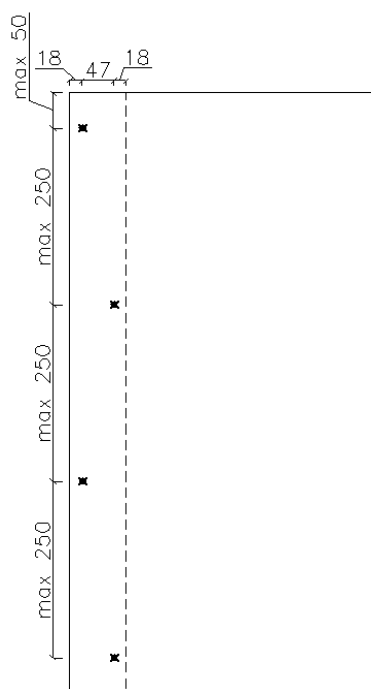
Vruty šroubované horizontálně pod úhlem 45° varianta a)
